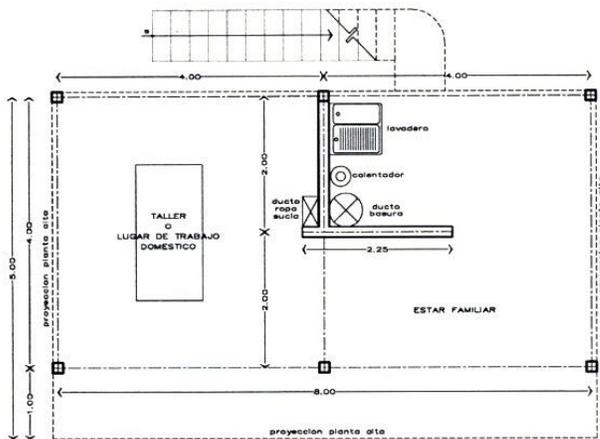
Proyecto Transición (Planta Baja). Concurso de Habitación Obrera, vivienda unifamiliar, Juan O’Gorman, 1932.
